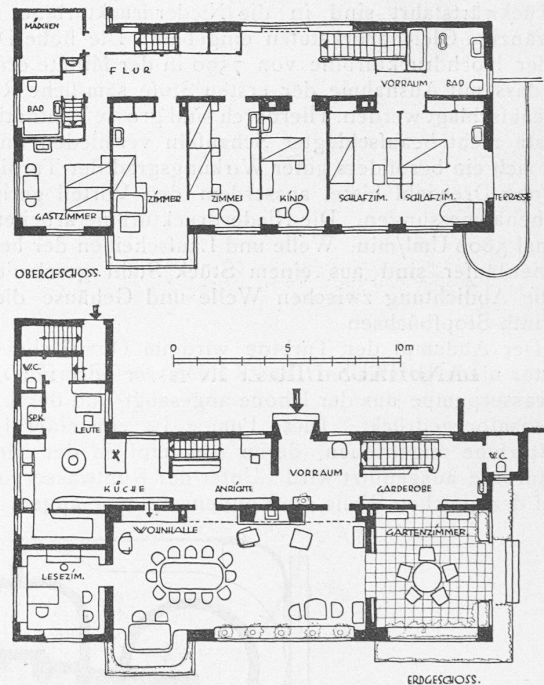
u. 2. Grundrisse zum Landhaus Dir. Z. in Klosterheide. — 1 : 300.
